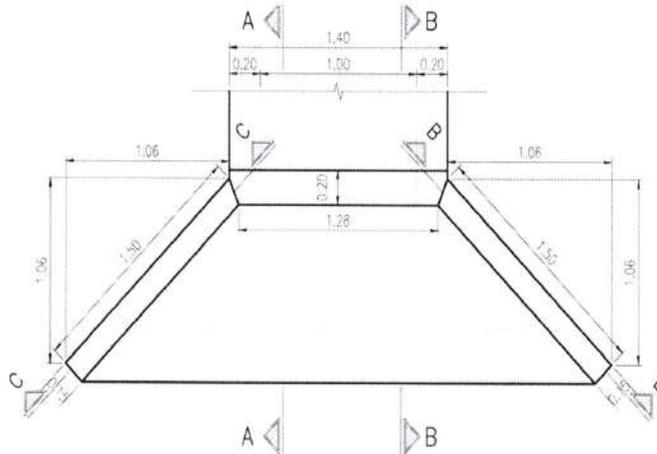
Sección típica de aletas de alcantarilla circular de 36" en Tramo Vial Mariangola – Villa Germania.
